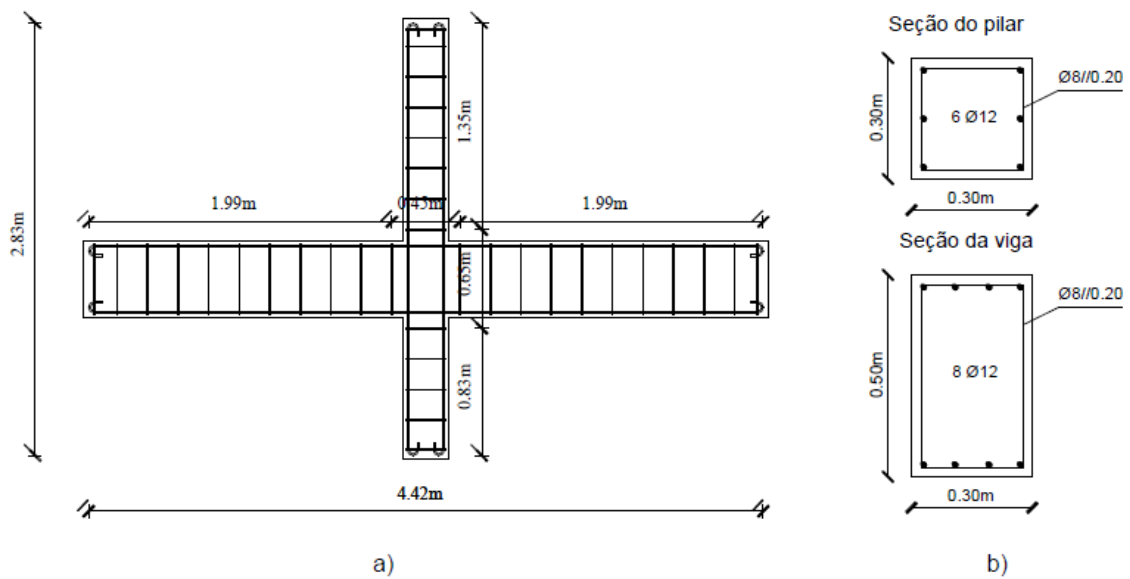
Armadura dos provetes IPA-1 e IPA-2: a) planta; b) corte; adaptado Garcia (2011)
